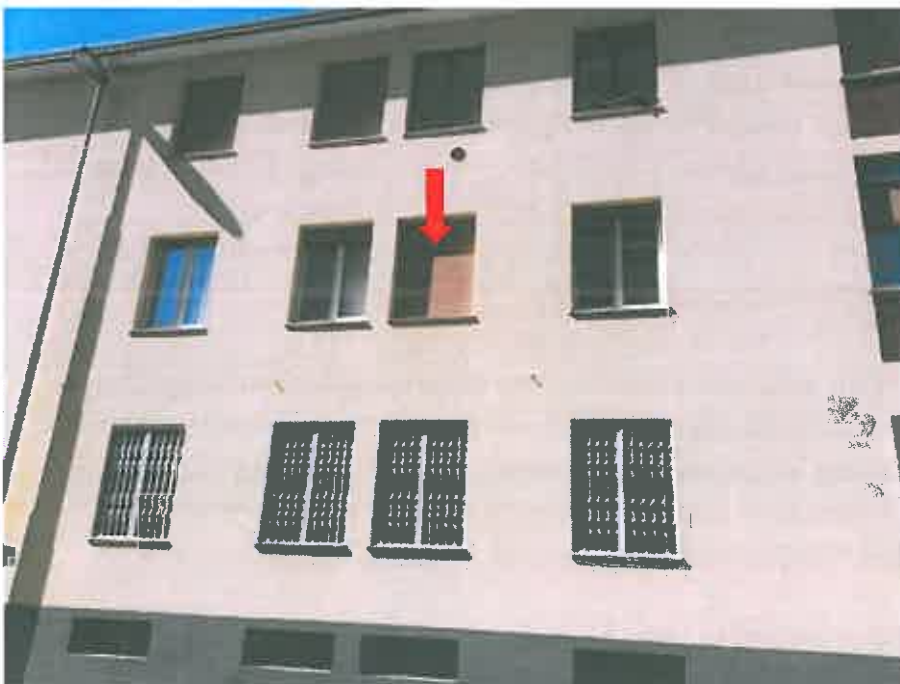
fronte Sud Via Parini – vano finestra cieco realizzato attraverso muratura interna di tamponamento
